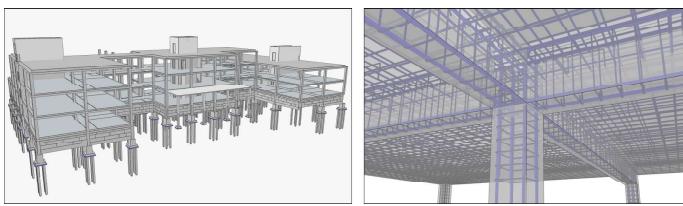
Железобетонный каркас здания и армирование несущих элементов каркаса
